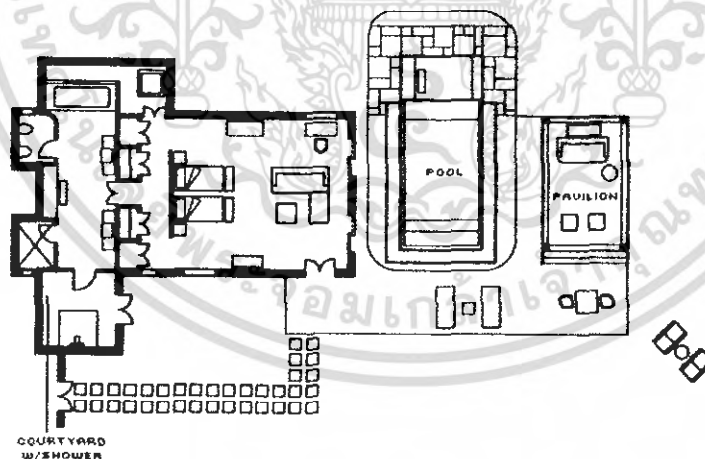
ตัวอย่างการจัดองค์ประกอบห้องพักแบบ Garden View Pavilion
